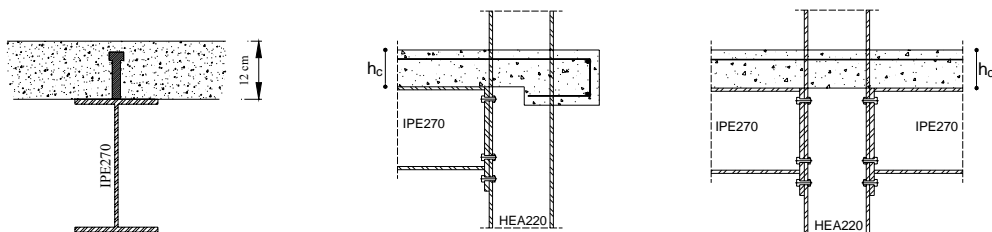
Pormenores dos elementos estruturais; a) secção mista, b) nó externo, c) nó interno.
